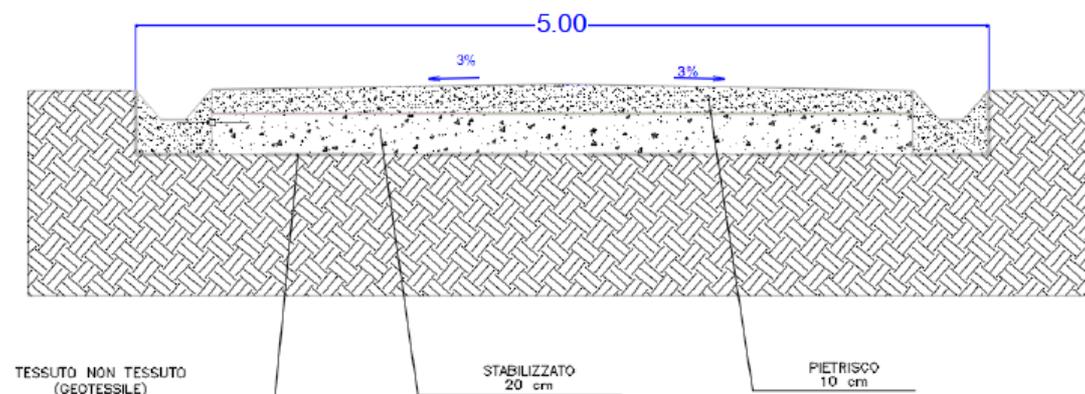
Sezione tipo Strada di servizio interna all'impianto
